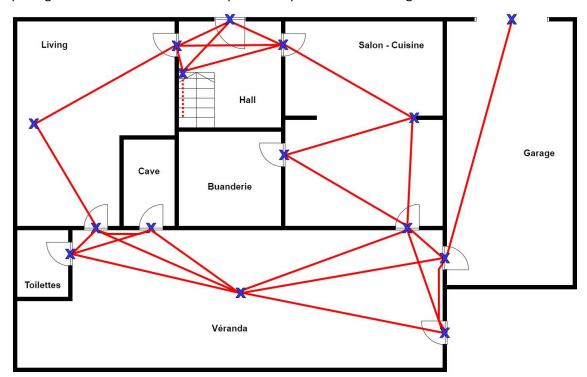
Plan du bâtiment de test - Rez-de-chaussée
